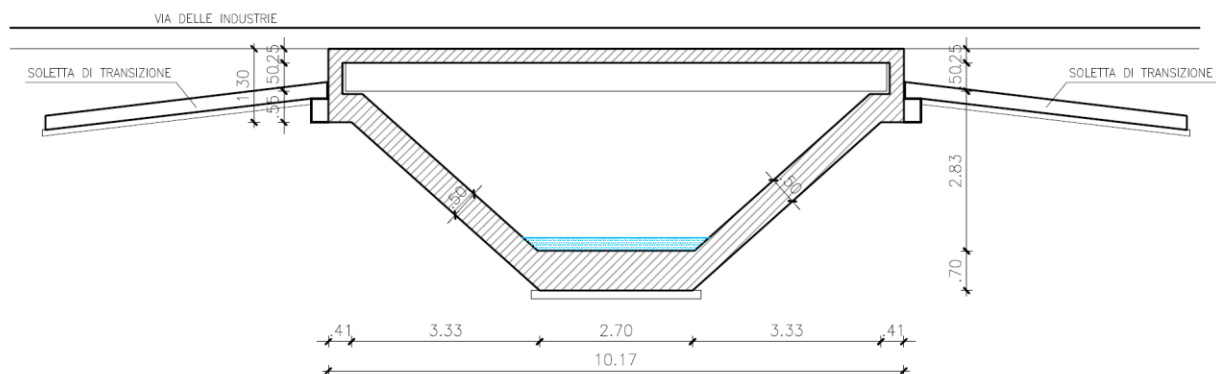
Sezione trasversale ponte sul fiume Dosson
